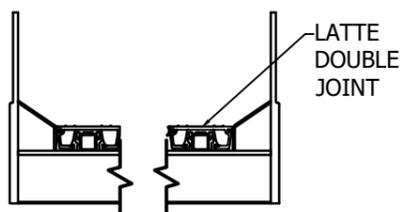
PIÈCE FORMÉE JOINT LATÉRAL
